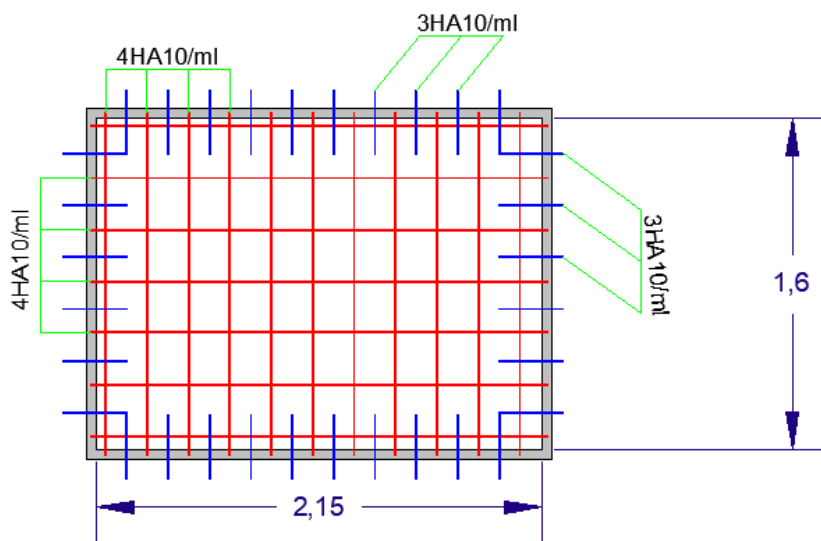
Ferrailage totale de la dalle pleine d'ascenseur
